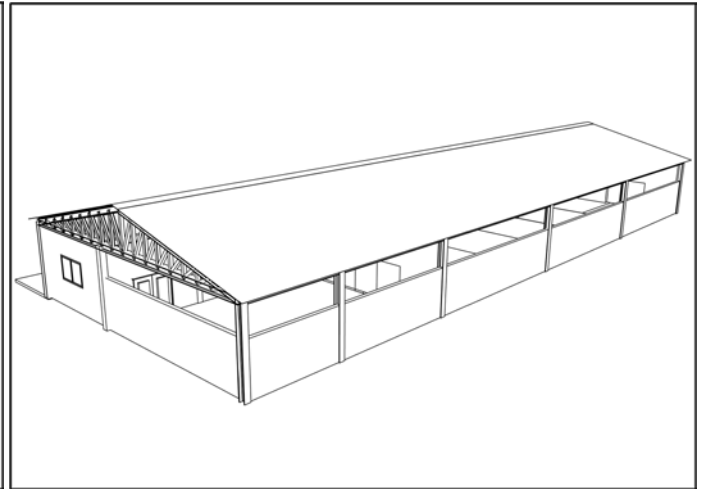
vue en perspective (façade postérieure) – étable longitudinale pour 30 vaches laitières.
